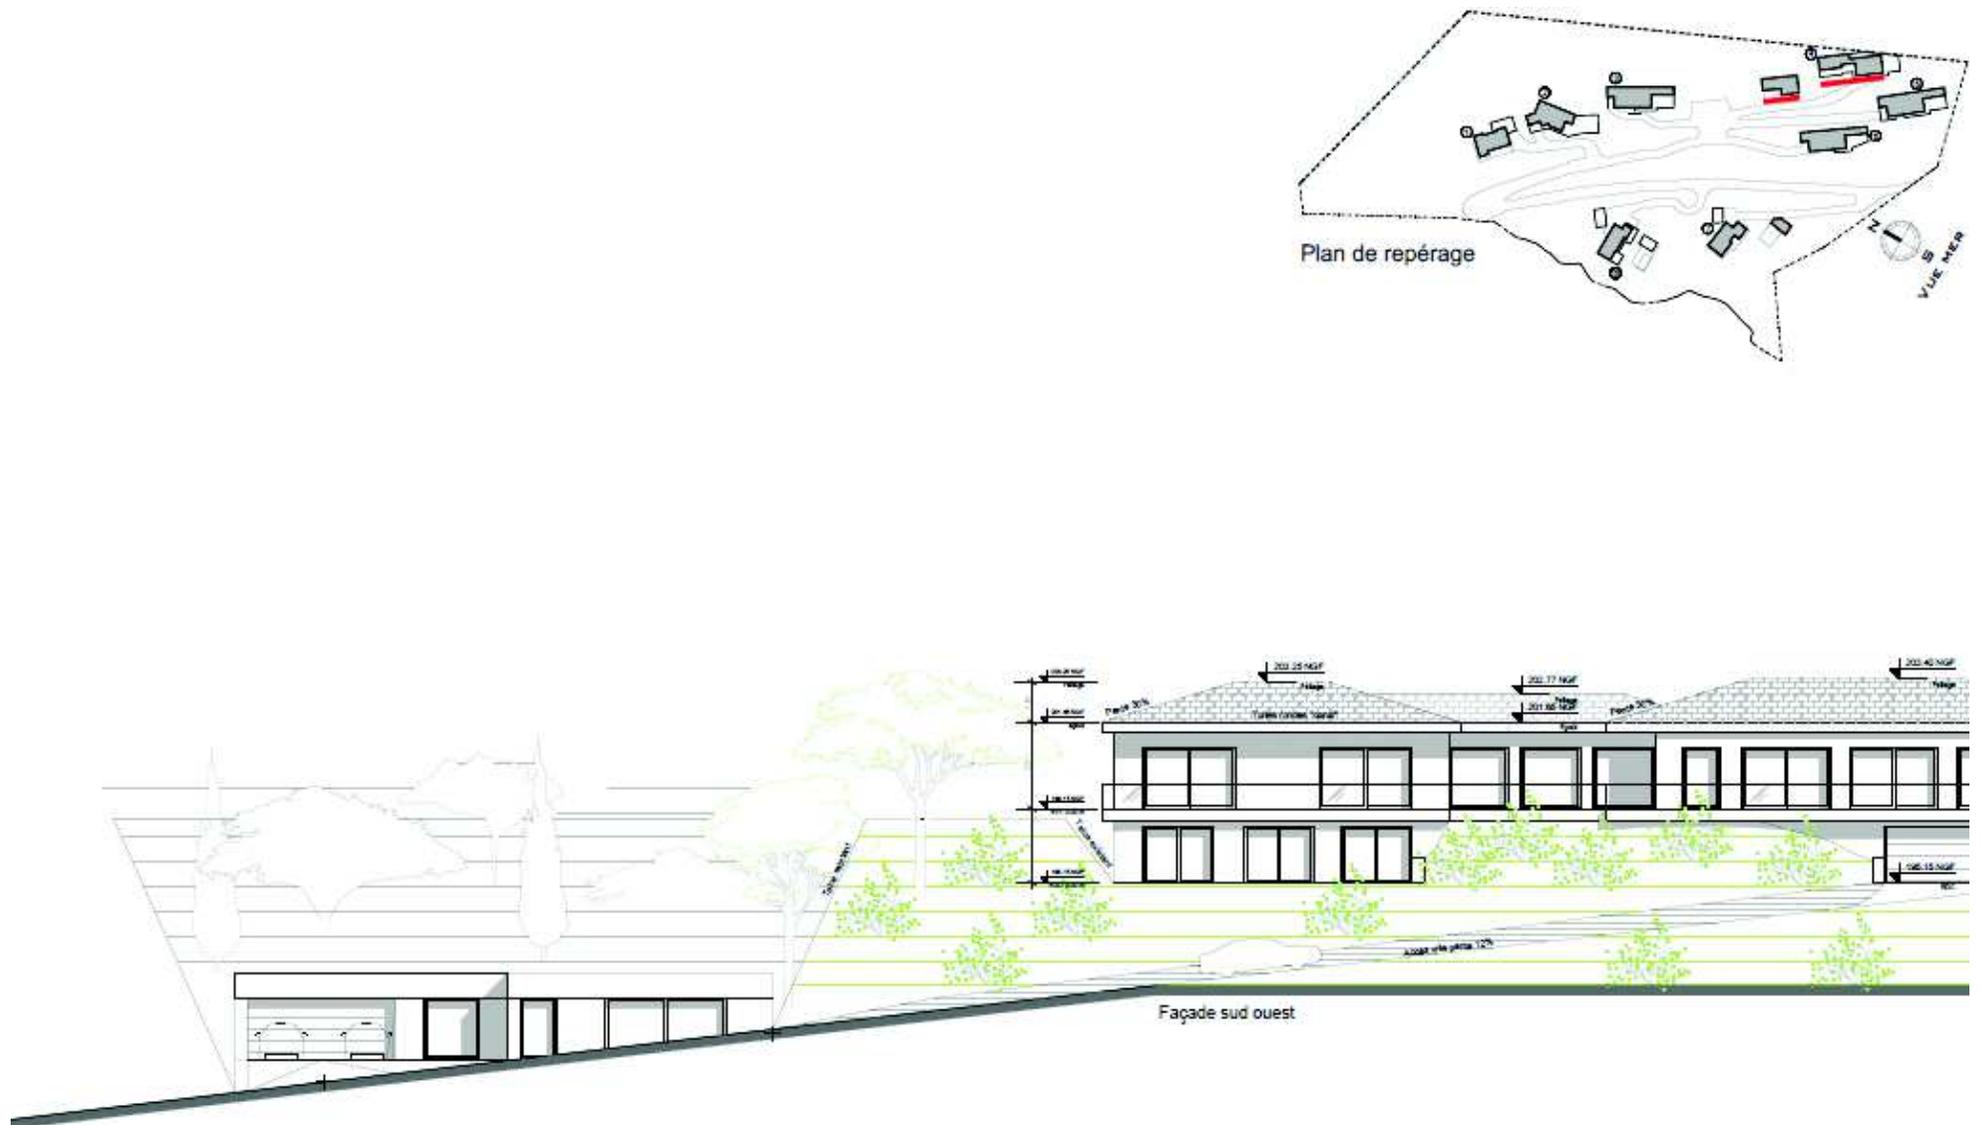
Façade de la villa 4 et de sa maison de gardien
